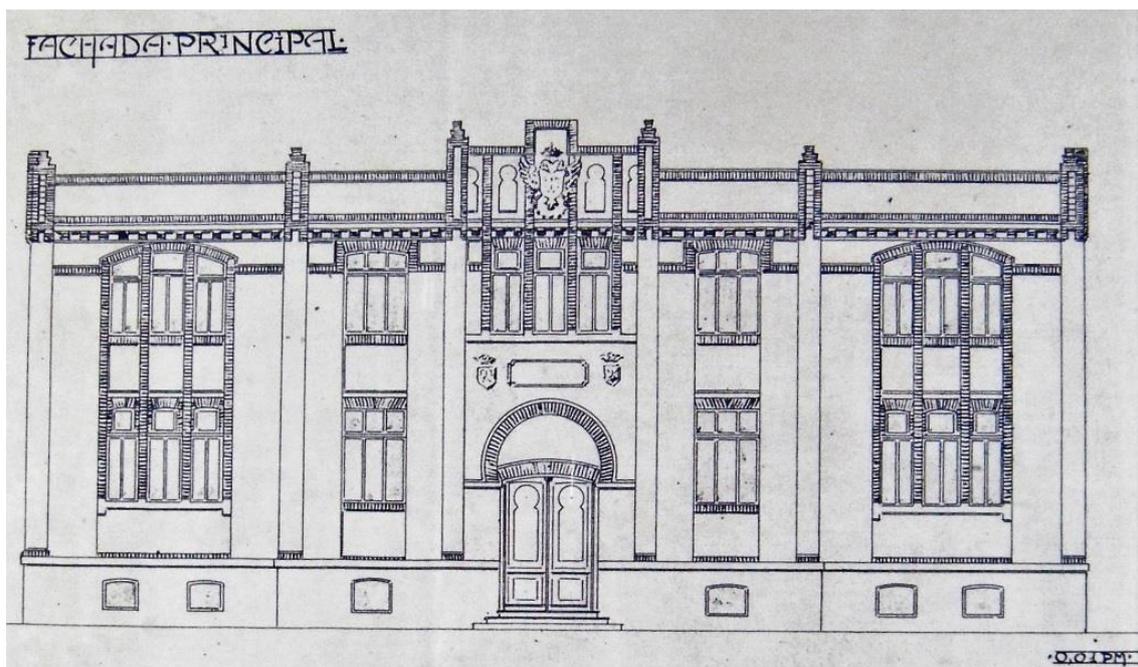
Fachada de las escuelas Alfonso XIII (ADT, Caja 318)
